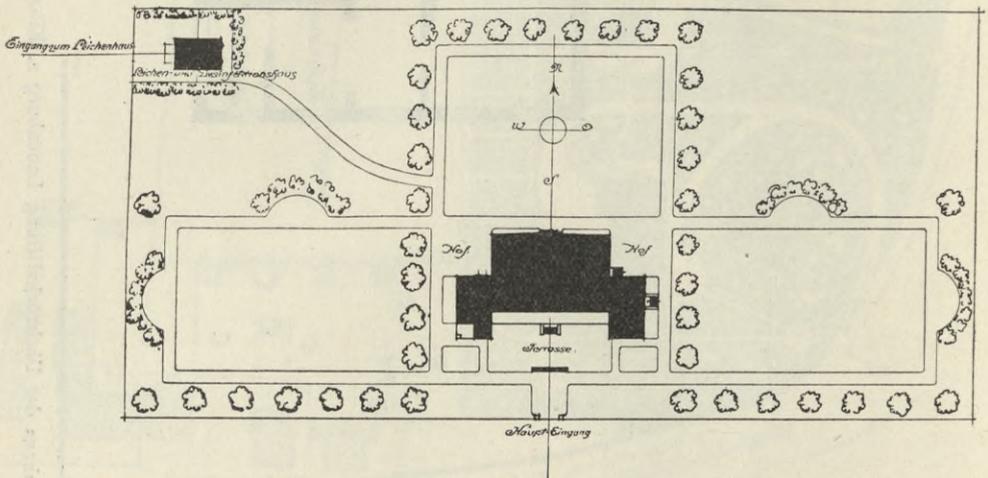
Entwurf für ein kleines Kreiskrankenhaus. Lageplan.
